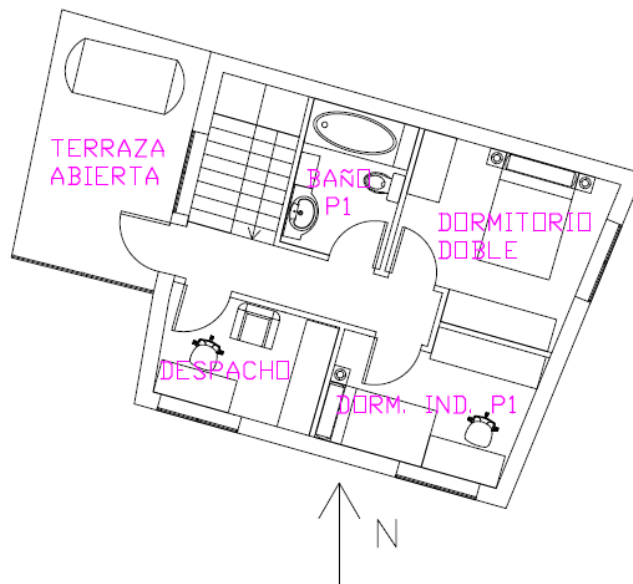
Distribución de la planta P1 de la vivienda. Fuente: elaboración propia.
